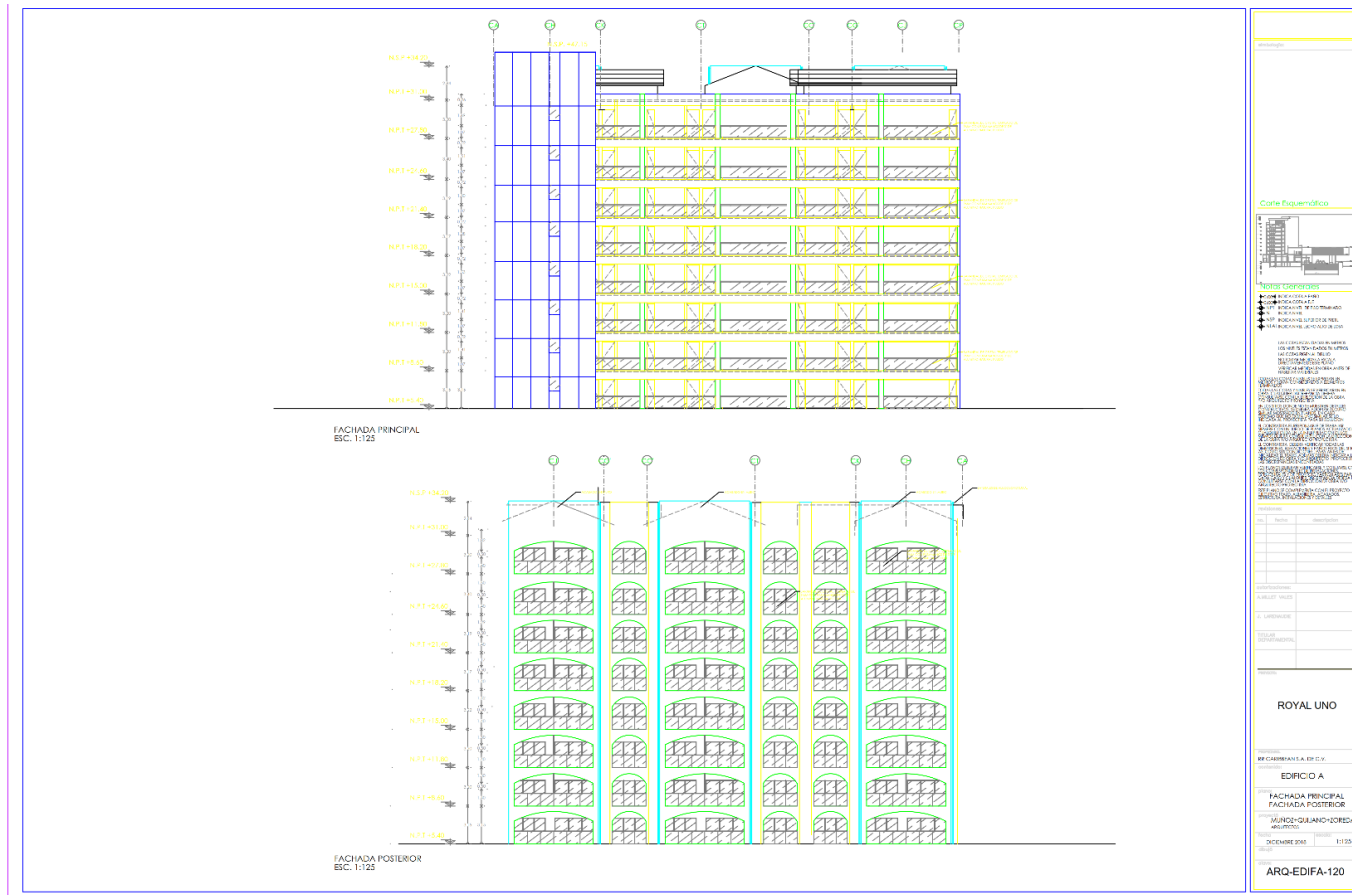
Edificio A, Fachada posterior y principal. Anexo C-7.
